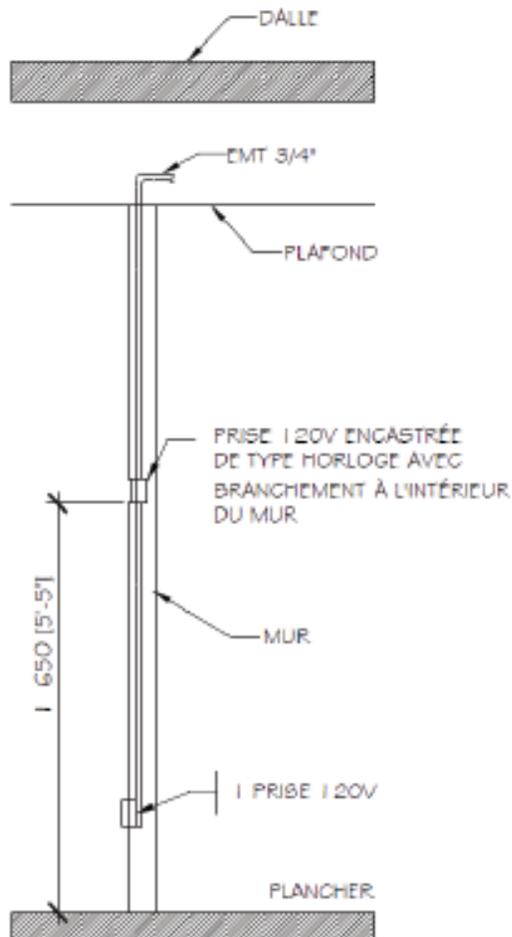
Installation ÉPI : Plan de coupe – Conduit et prises 120V
